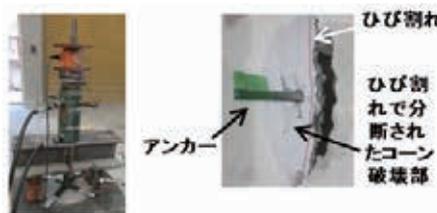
母材ひび割れのあと施工アンカー耐力への影響検討
